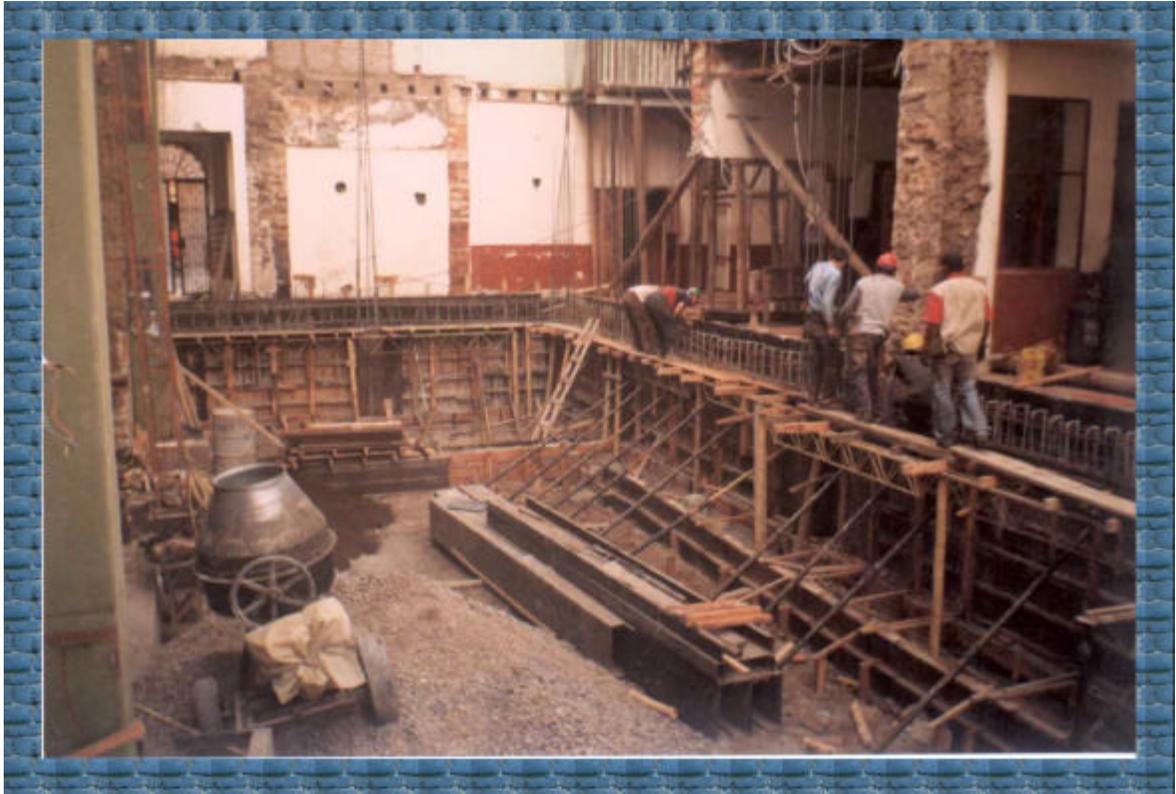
Se aprecia claramente la armada y figurada del hierro tanto para la primera viga como para las columnas correspondientes al segundo nivel
